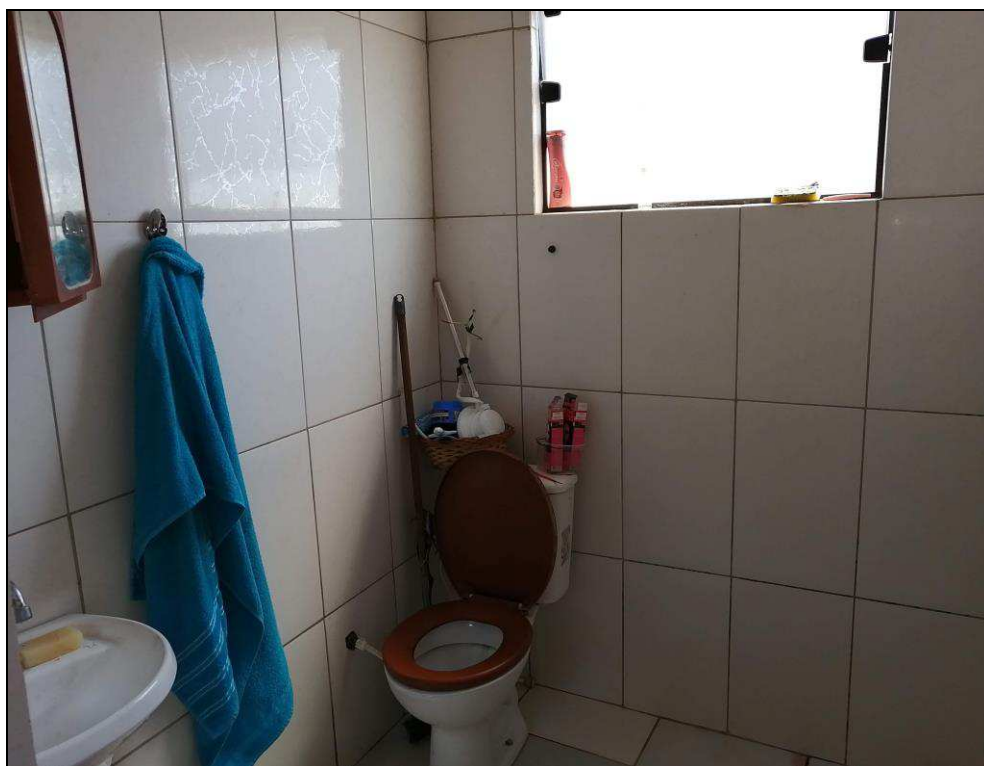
Detalhe parcial do banheiro da suíte, localizado no piso superior, onde podemos observar as principais características construtivas desse compartimento.
